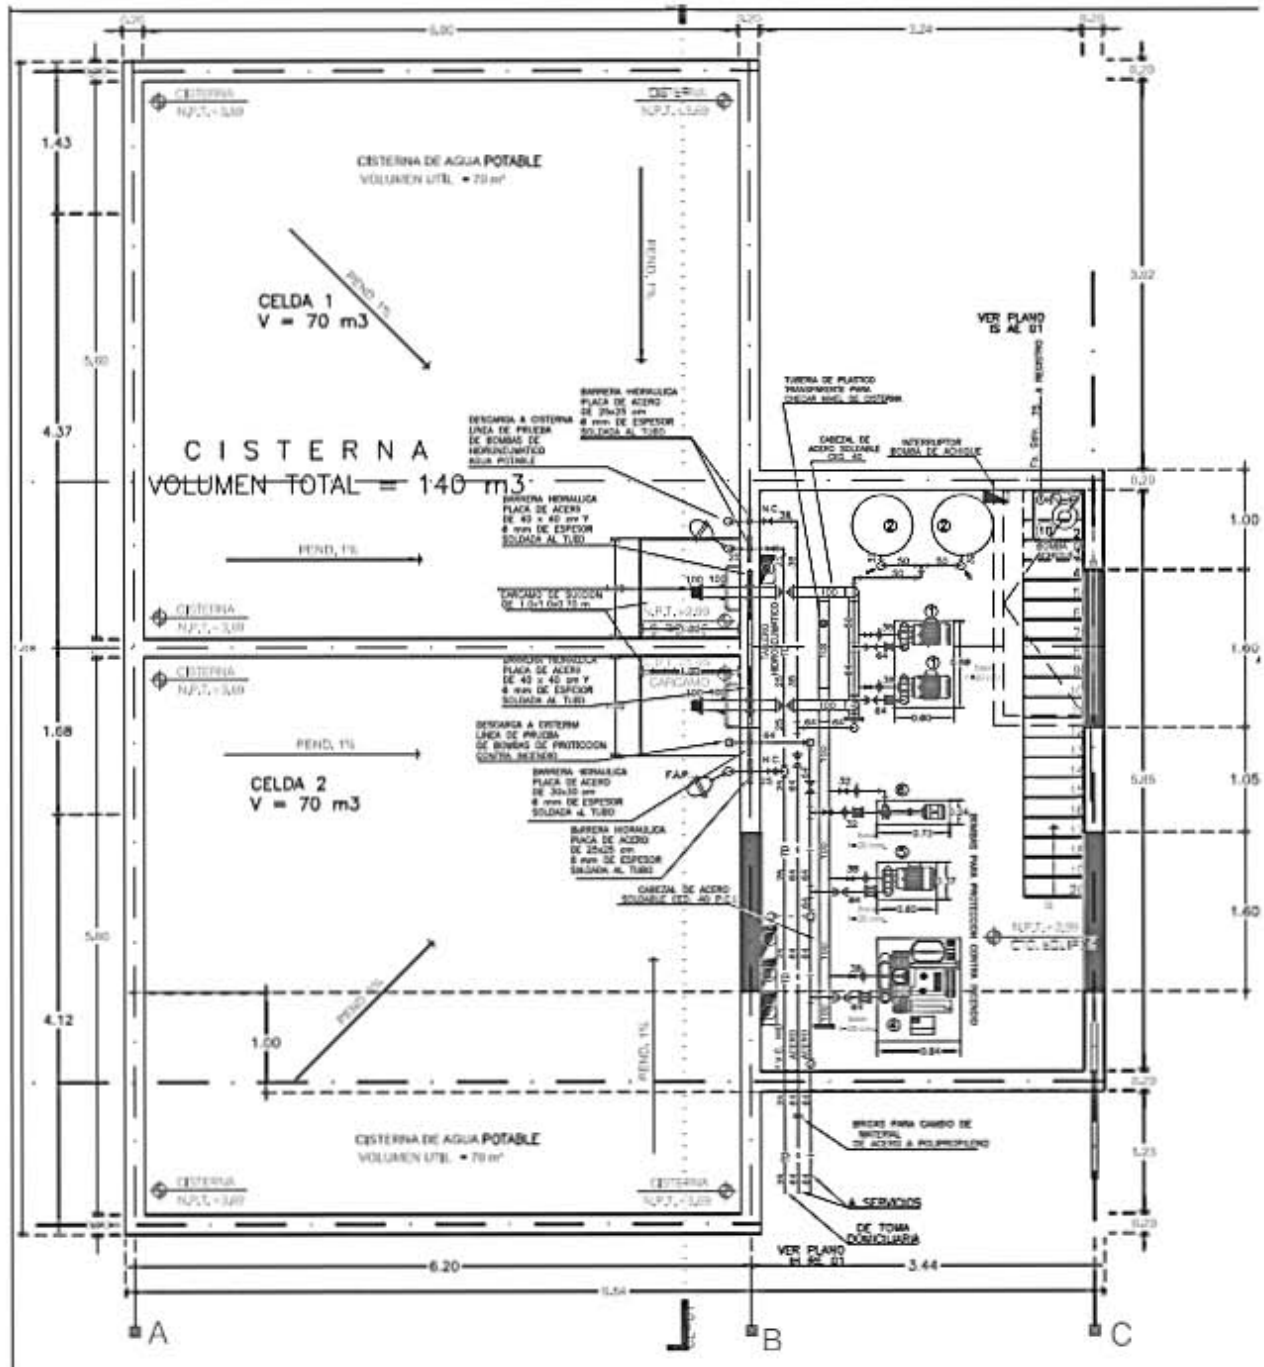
Vista en planta de la cisterna y cuarto de maquinas
